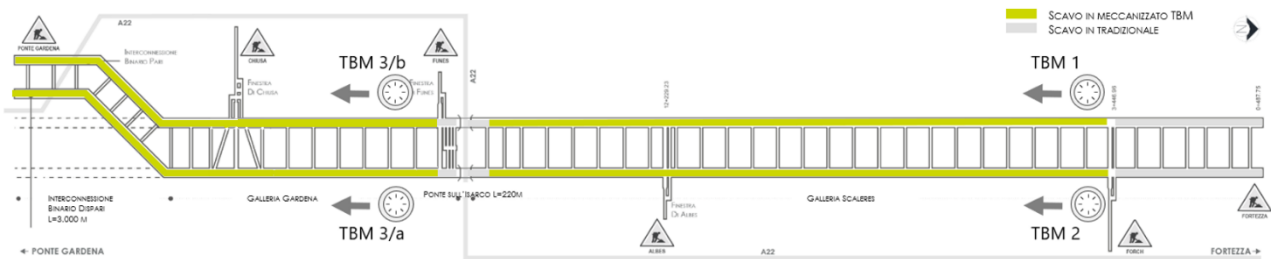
Schematico sistema gallerie Lotto 1
